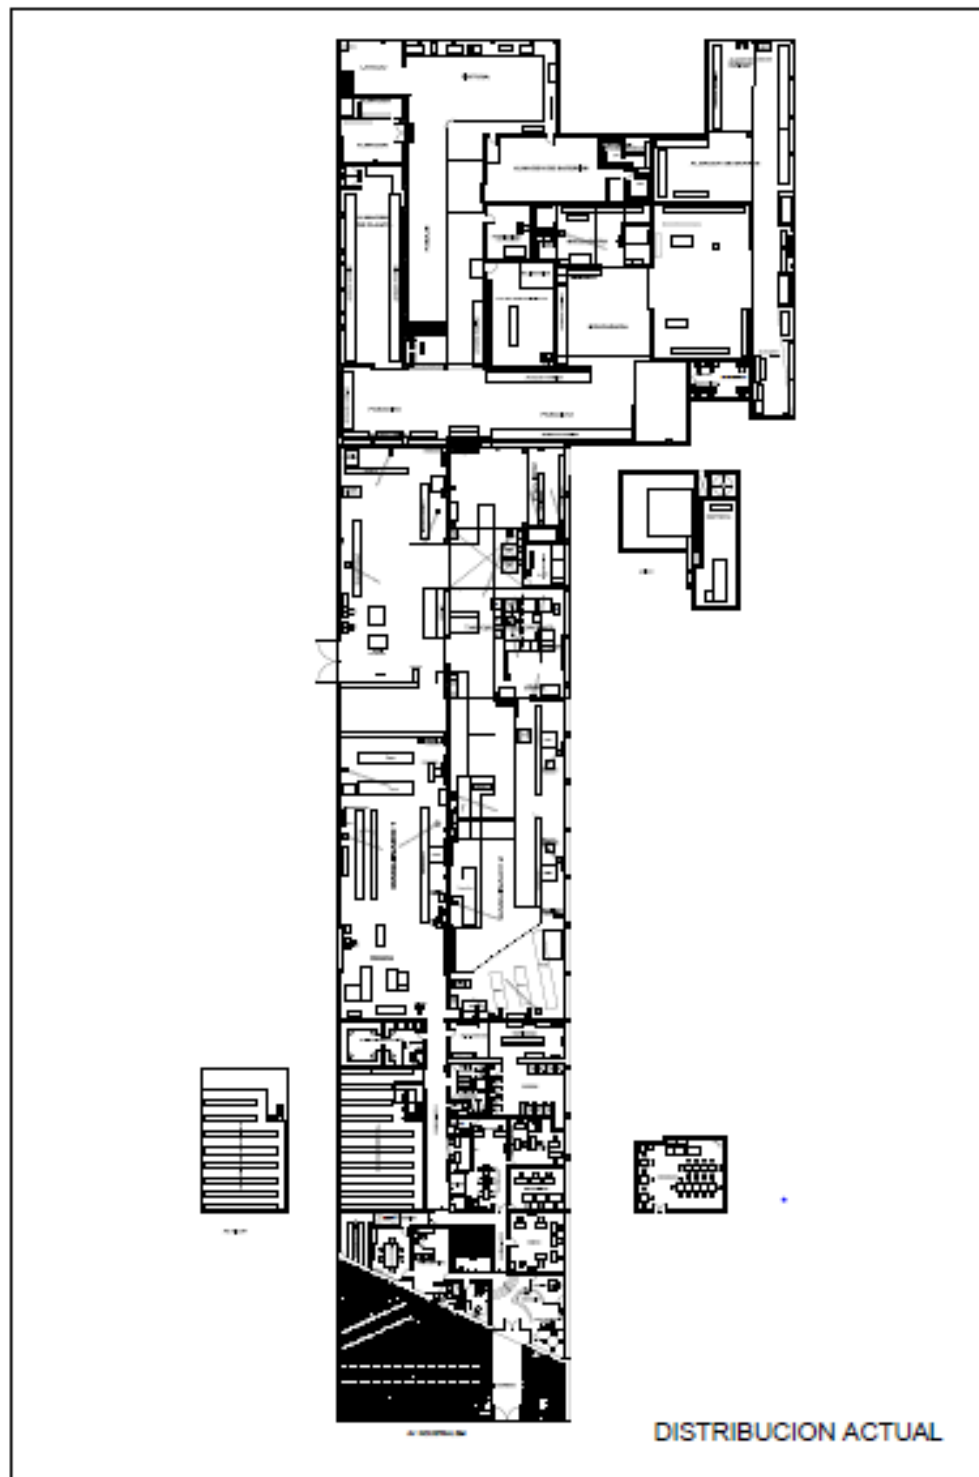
Plano actual de la distribución de la planta. Fuente: Empresa JMS.
